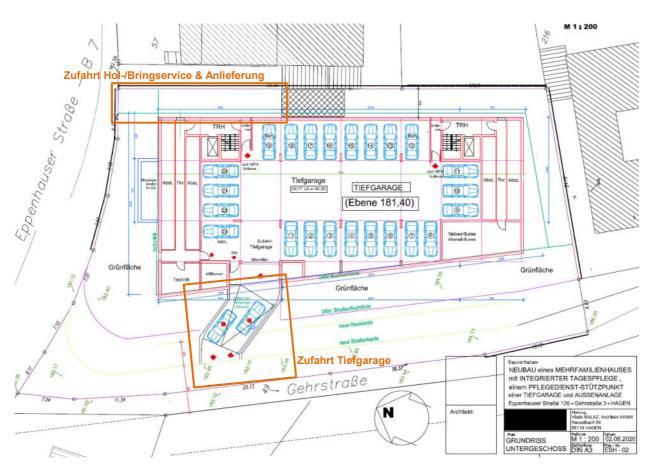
Geplante Erschließung des Plangrundstücks mit Zufahrt zur Tiefgarage über die Gehrstraße und Anlieferung über die Eppenhauser Straße; Grundlage aus [3]
